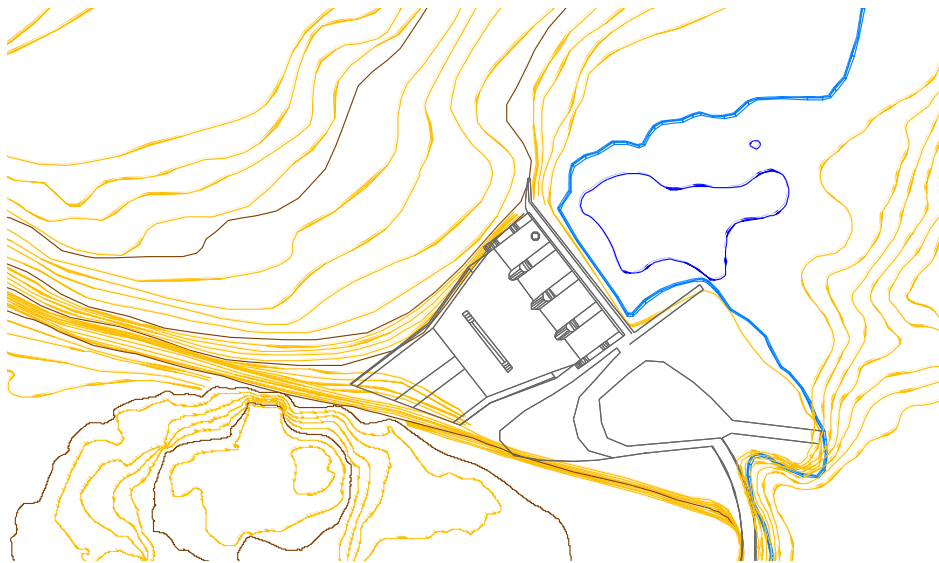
Planta del vertedor actual propuesto como obra de desvío.
